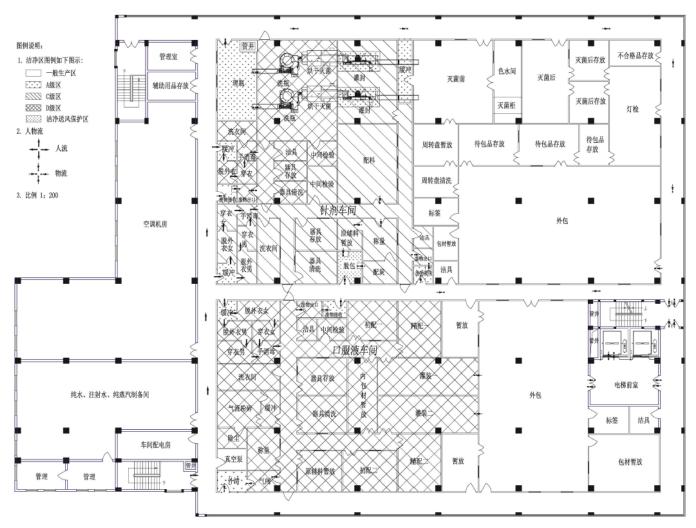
本项目变动前综合制剂生产车间三层平面布置图
